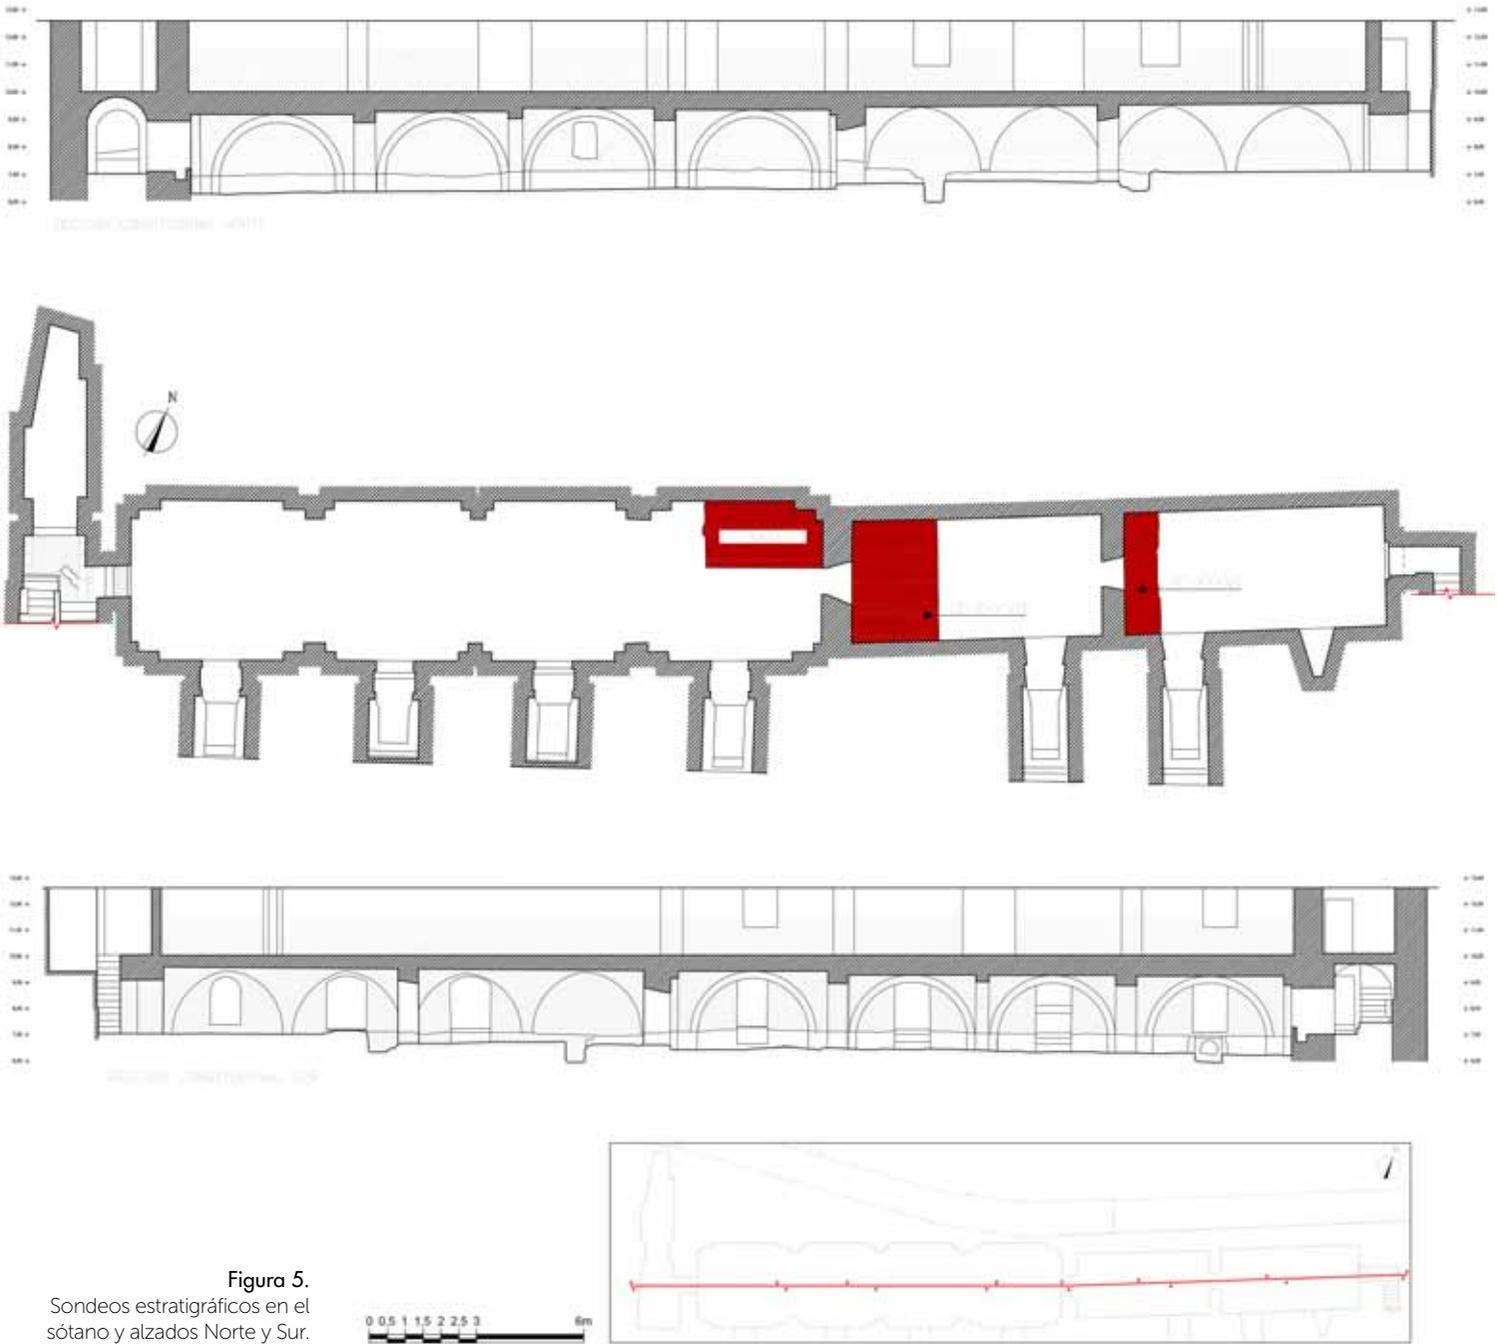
Sondajes estratigráficos en el sótano y alzados Norte y Sur.
